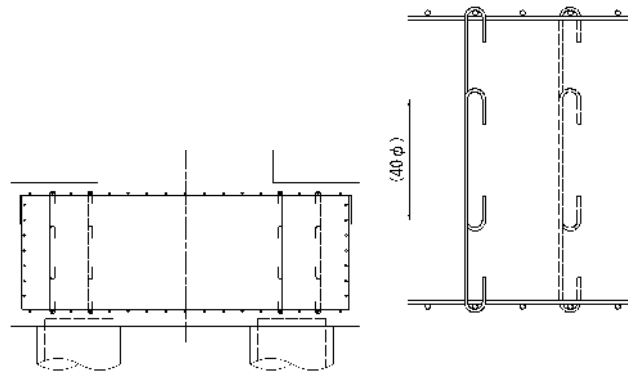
フーチングの標準的なせん断補強鉄筋形状および組立図の例
